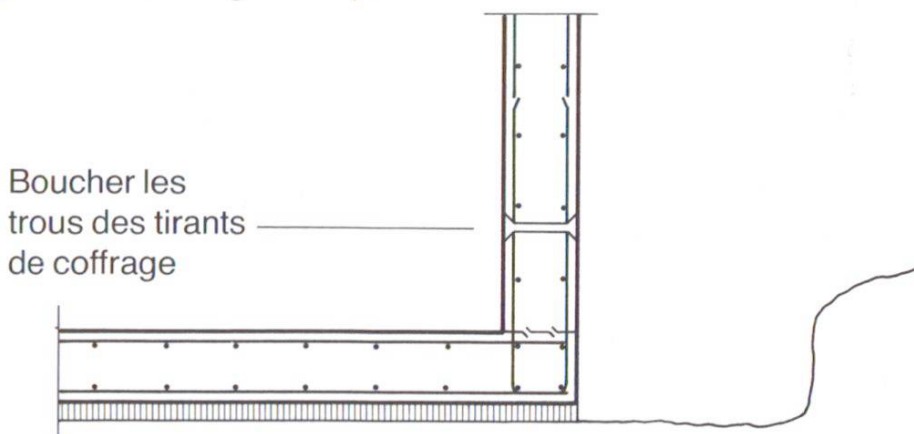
Coupe du raccordement plancher/paroi. Bétonnage de la paroi avec une précouche de mortier.
